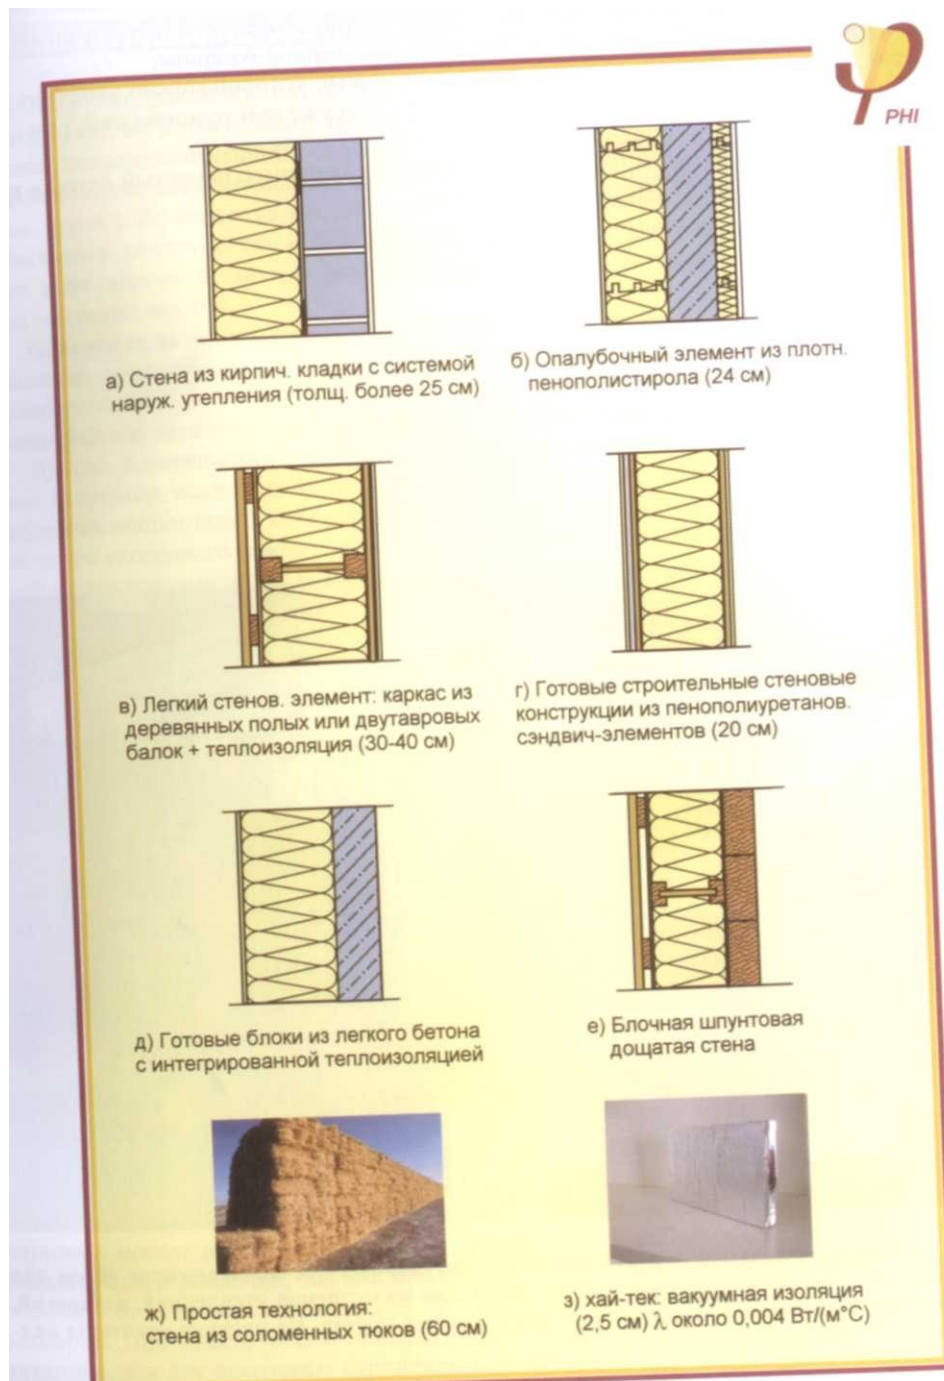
Конструкции наружных стен, пригодные для пассивных зданий
